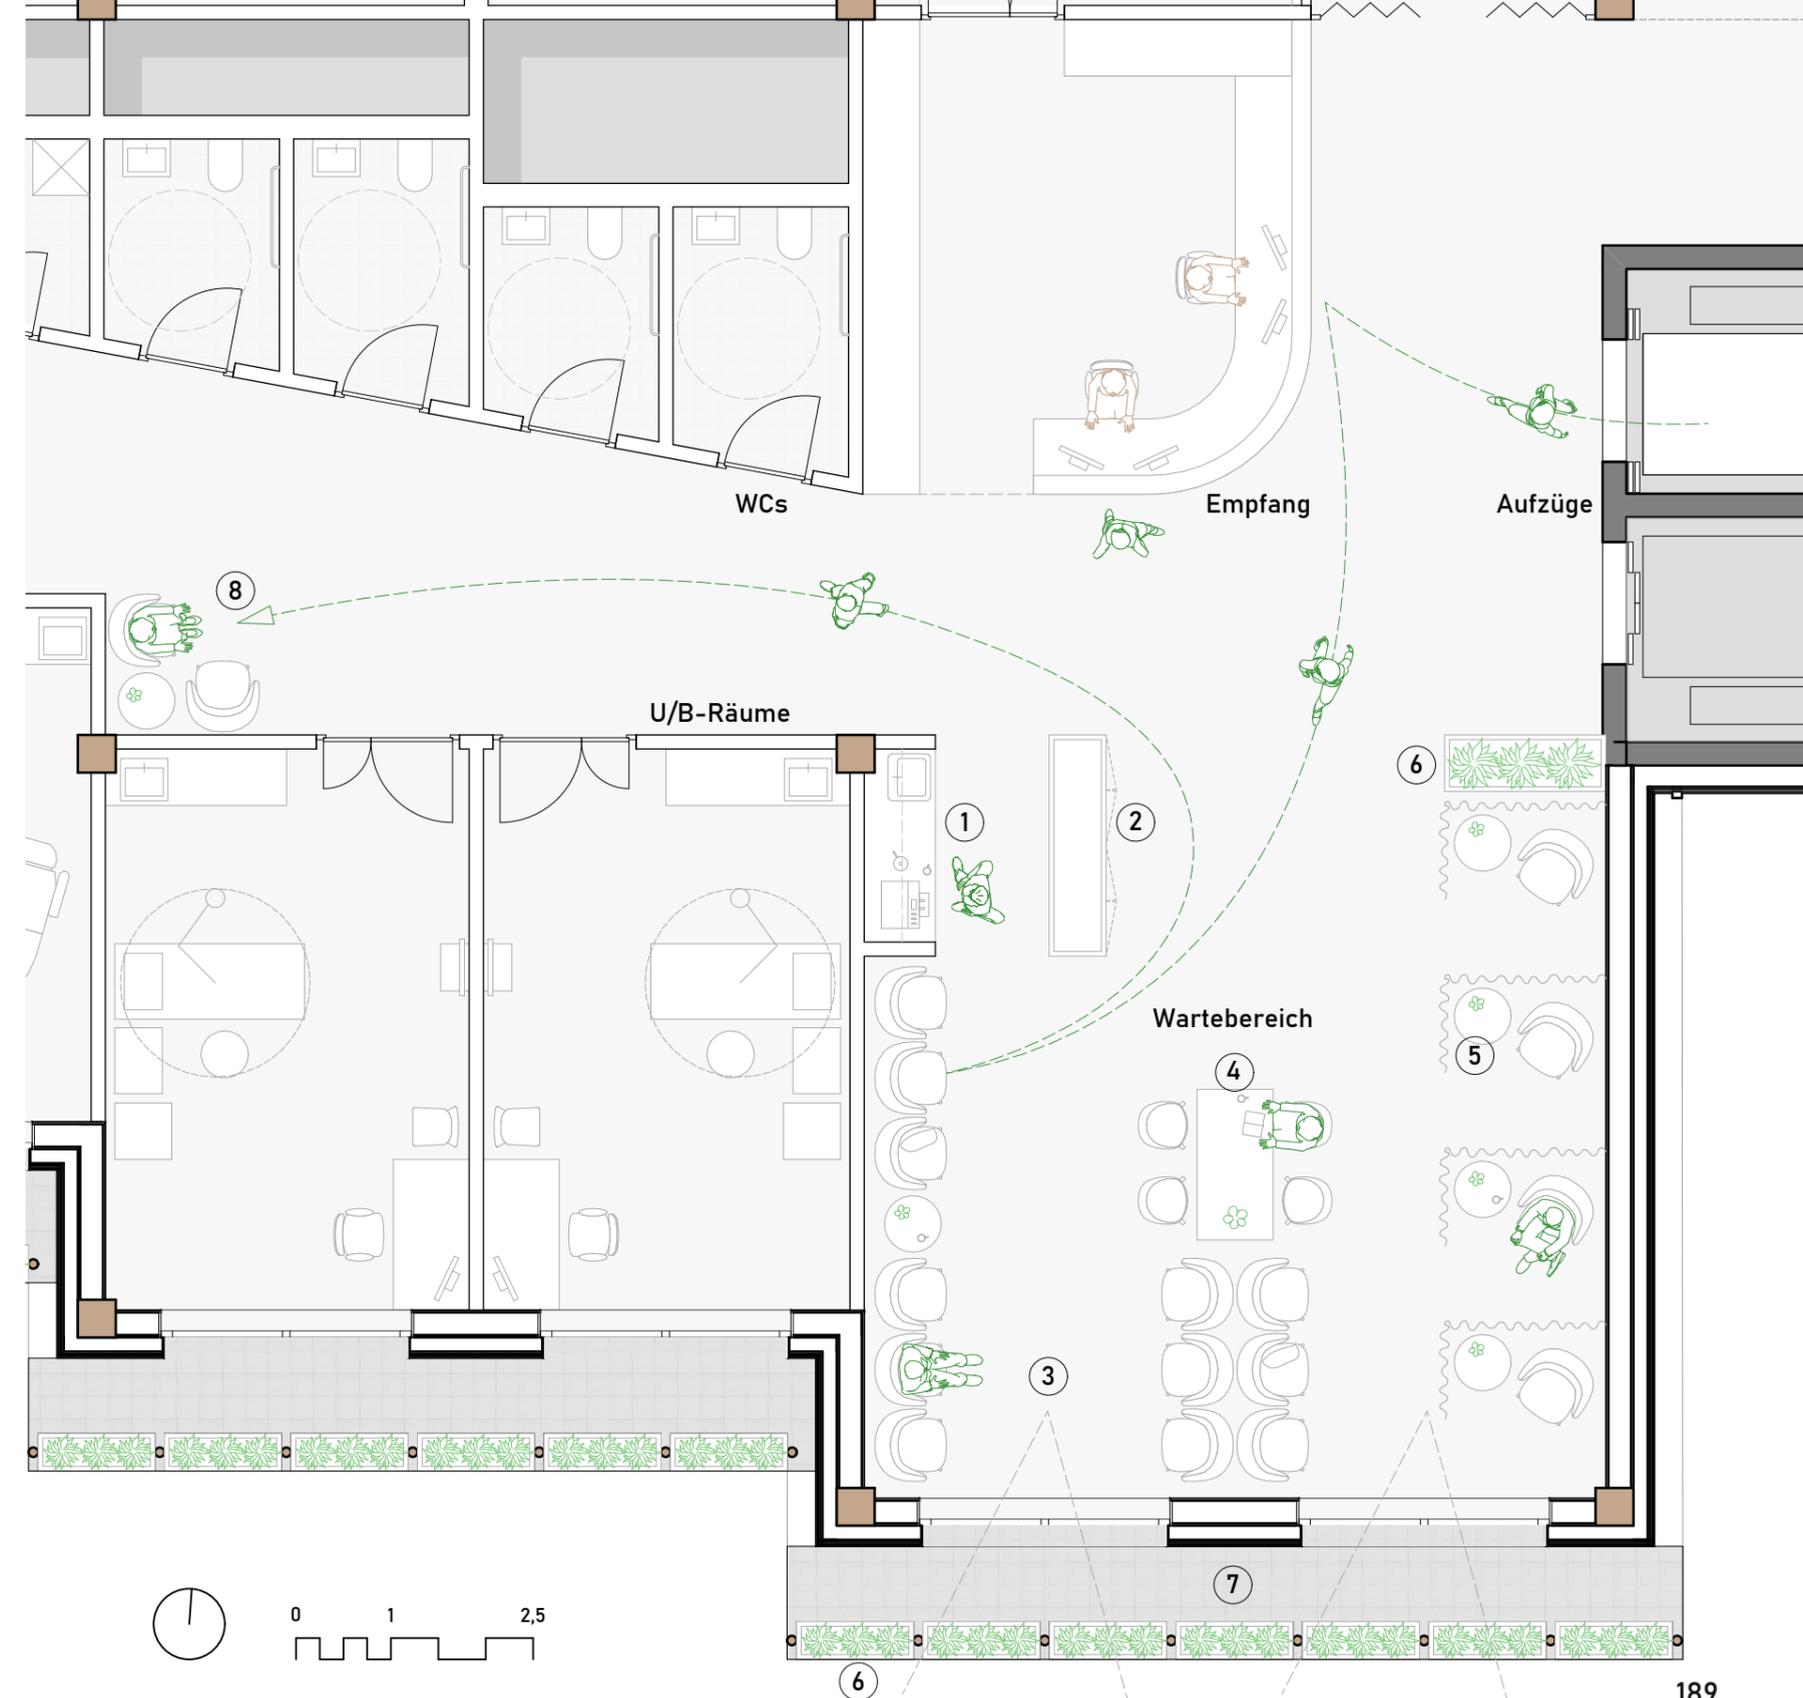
Grundrissausschnitt Wartebereich M1:75
